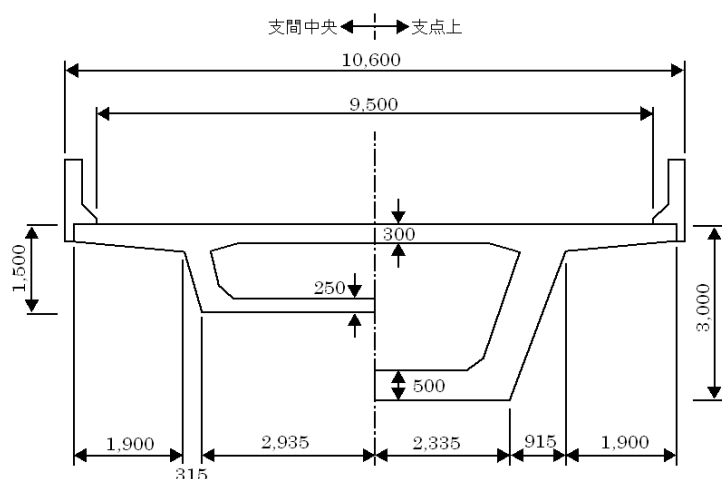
YH 橋(箱桁部)の標準断面図(単位:mm)
